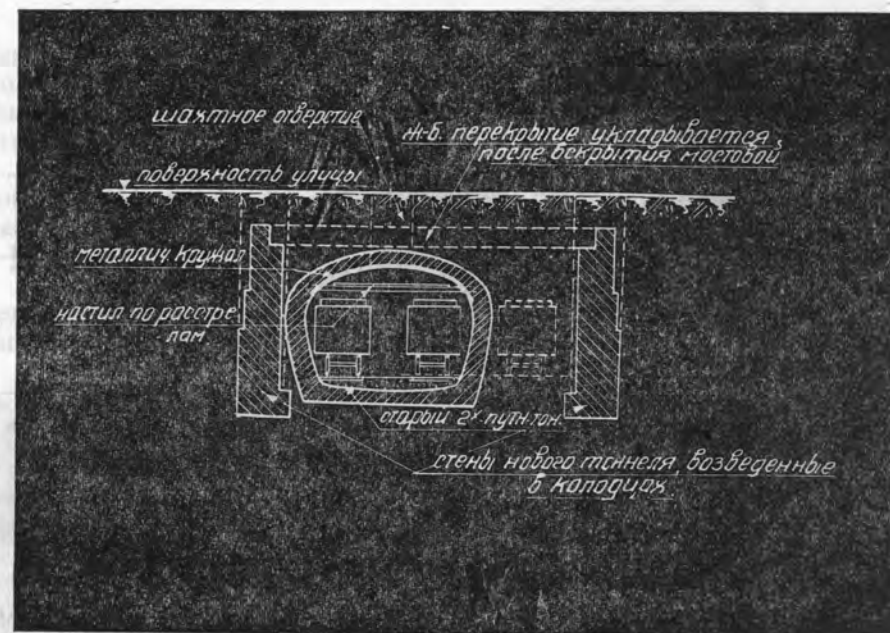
Реконструкция двухпутного тоннеля сводчатого профиля в трехпутный тоннель с плоским ж. б. перекрытием у станции метрополитена „Леколь-де Милитер“
